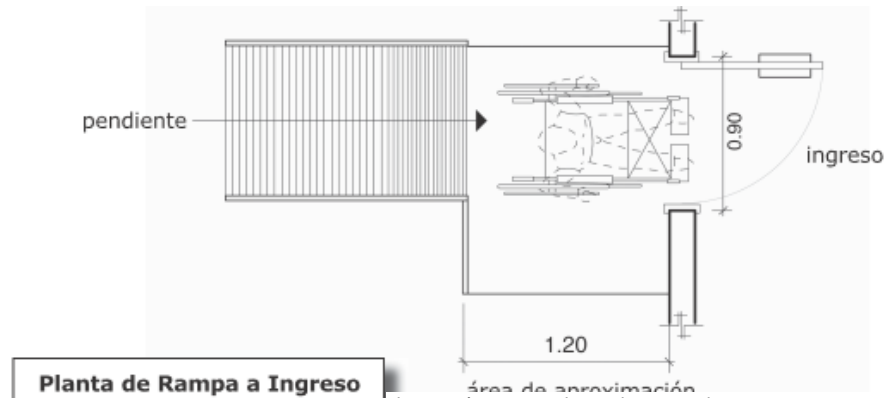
Planta de rampa de ingreso. Fuente: Manual técnico, 2005.
